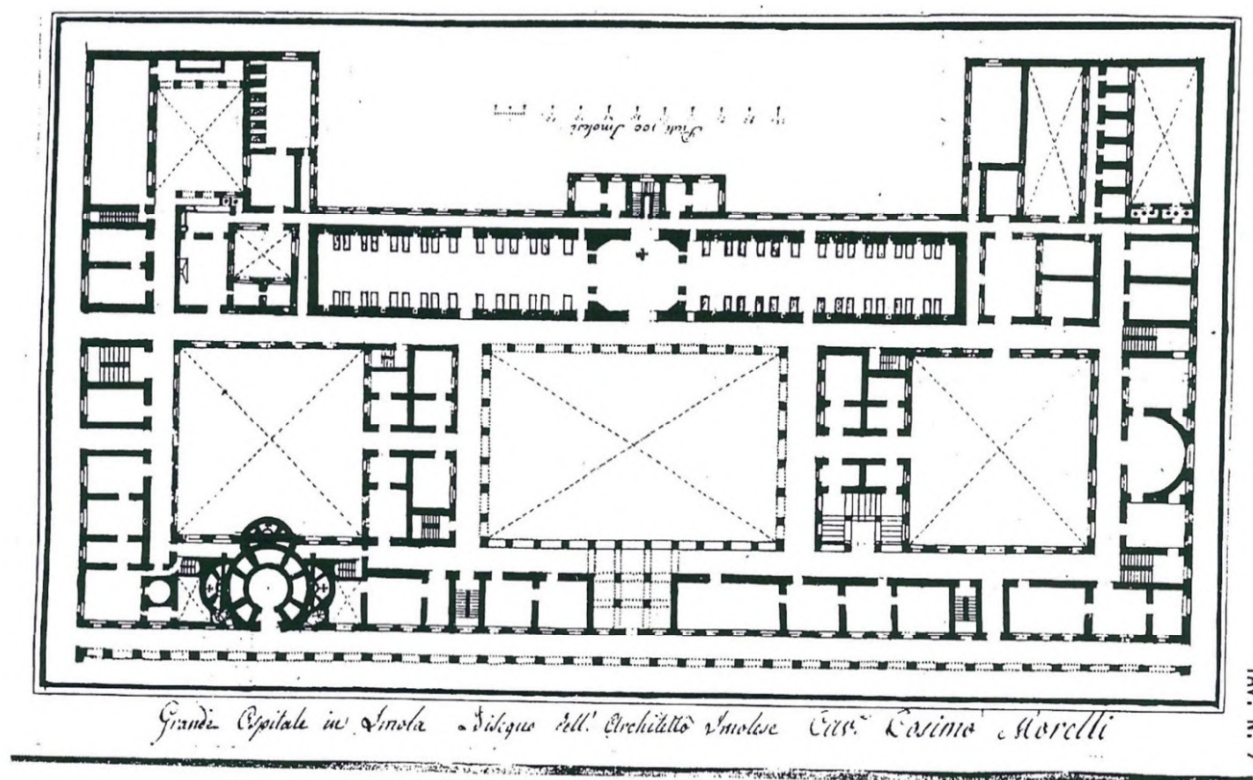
planimetria di progetto dell'Ospedale – arch. Cosimo Morelli
